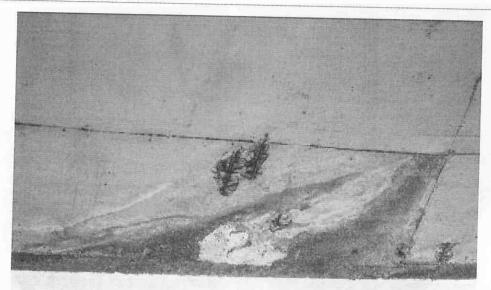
Vista geral frontal inferior da Passarela, detalhe de ausência de pingadeira laterais, processo de infiltração e armaduras expostas
